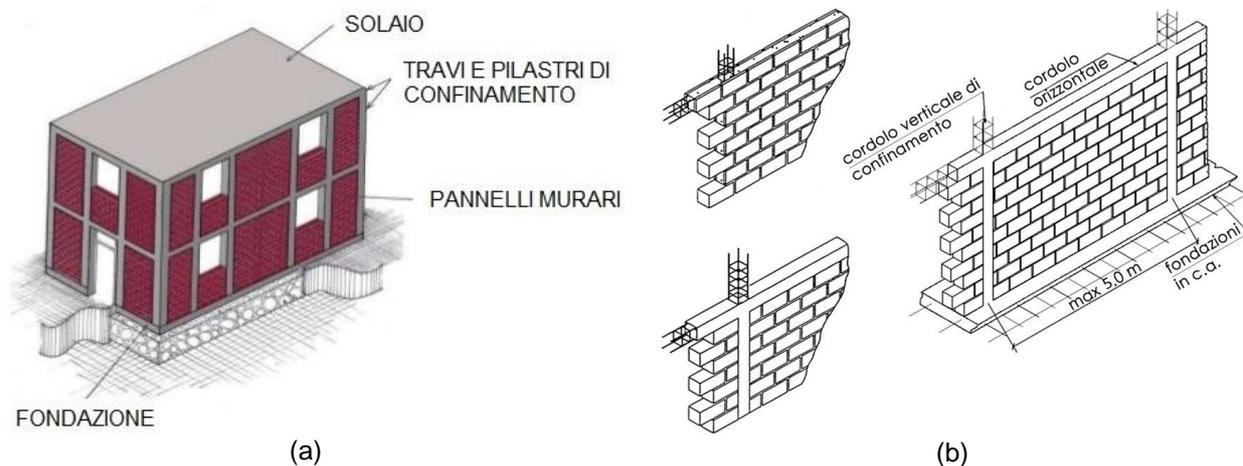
Edificio in muratura confinata: (a) struttura d'insieme e b) dettagli costruttivi.
